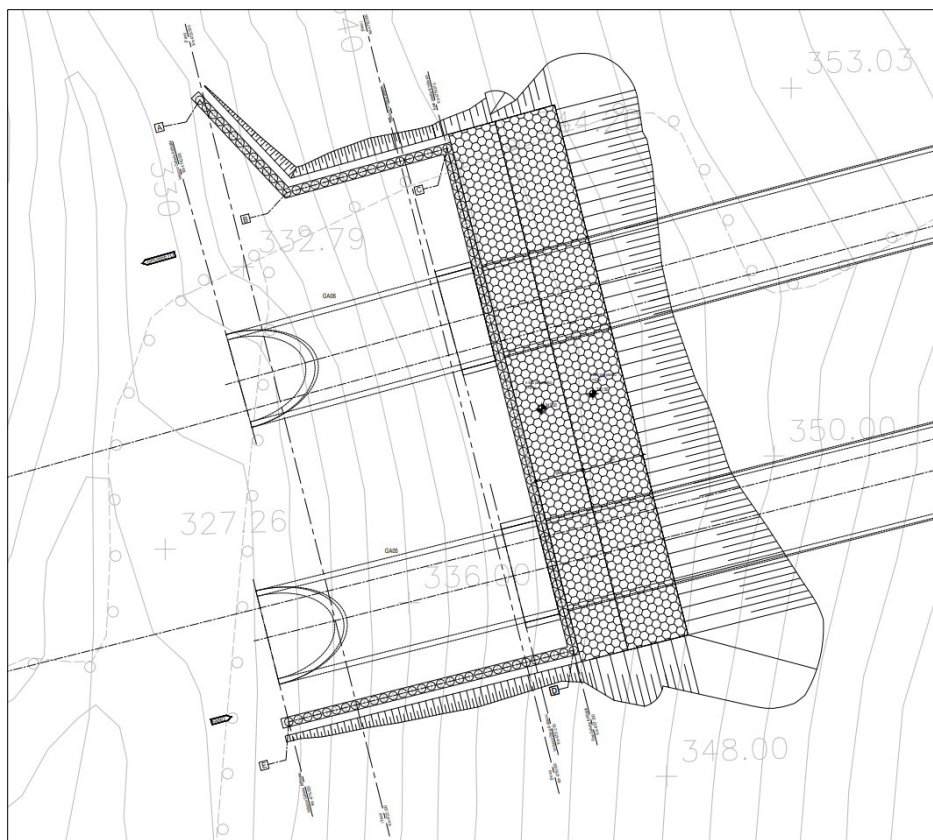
Planimetria delle gallerie artificiali di imbocco GA05 e GA06
